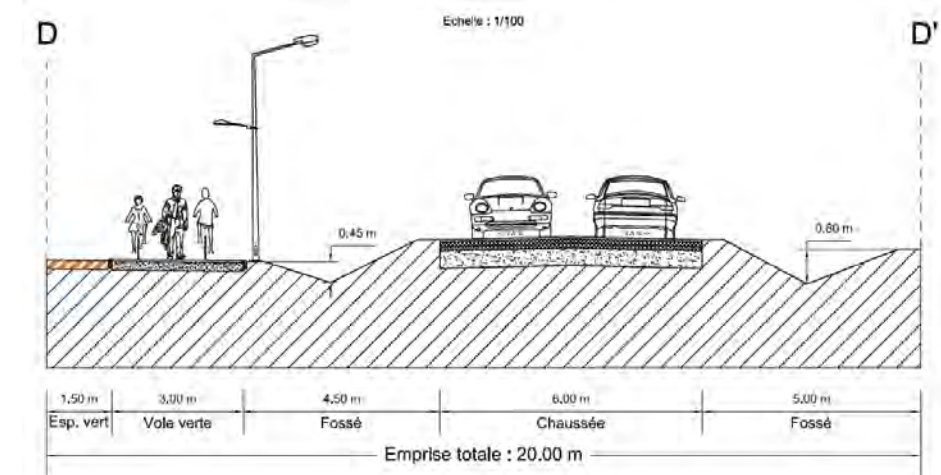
PROFIL EN TRAVERS ROUTE DU CUJAC - PARTIE NORD (SOURCE : J2C)
